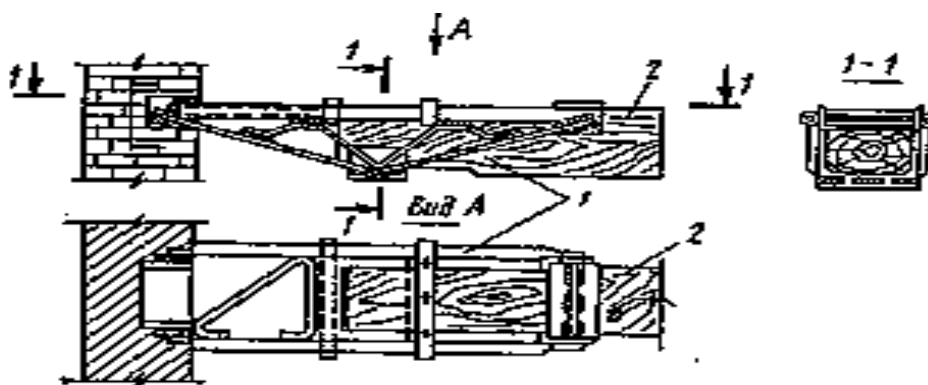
Усиление балок перекрытия прутковыми протезами:
